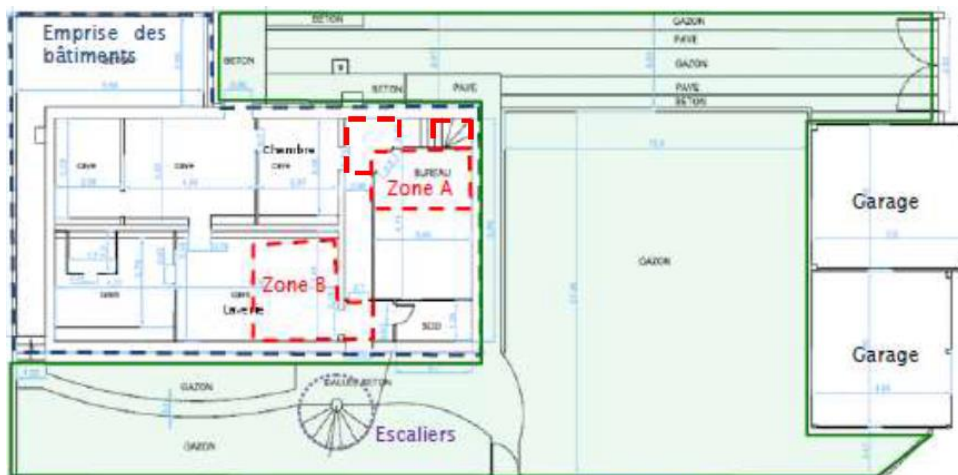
plan de la parcelle « site de Chaville 4 » et zones de travaux dans l'habitation
